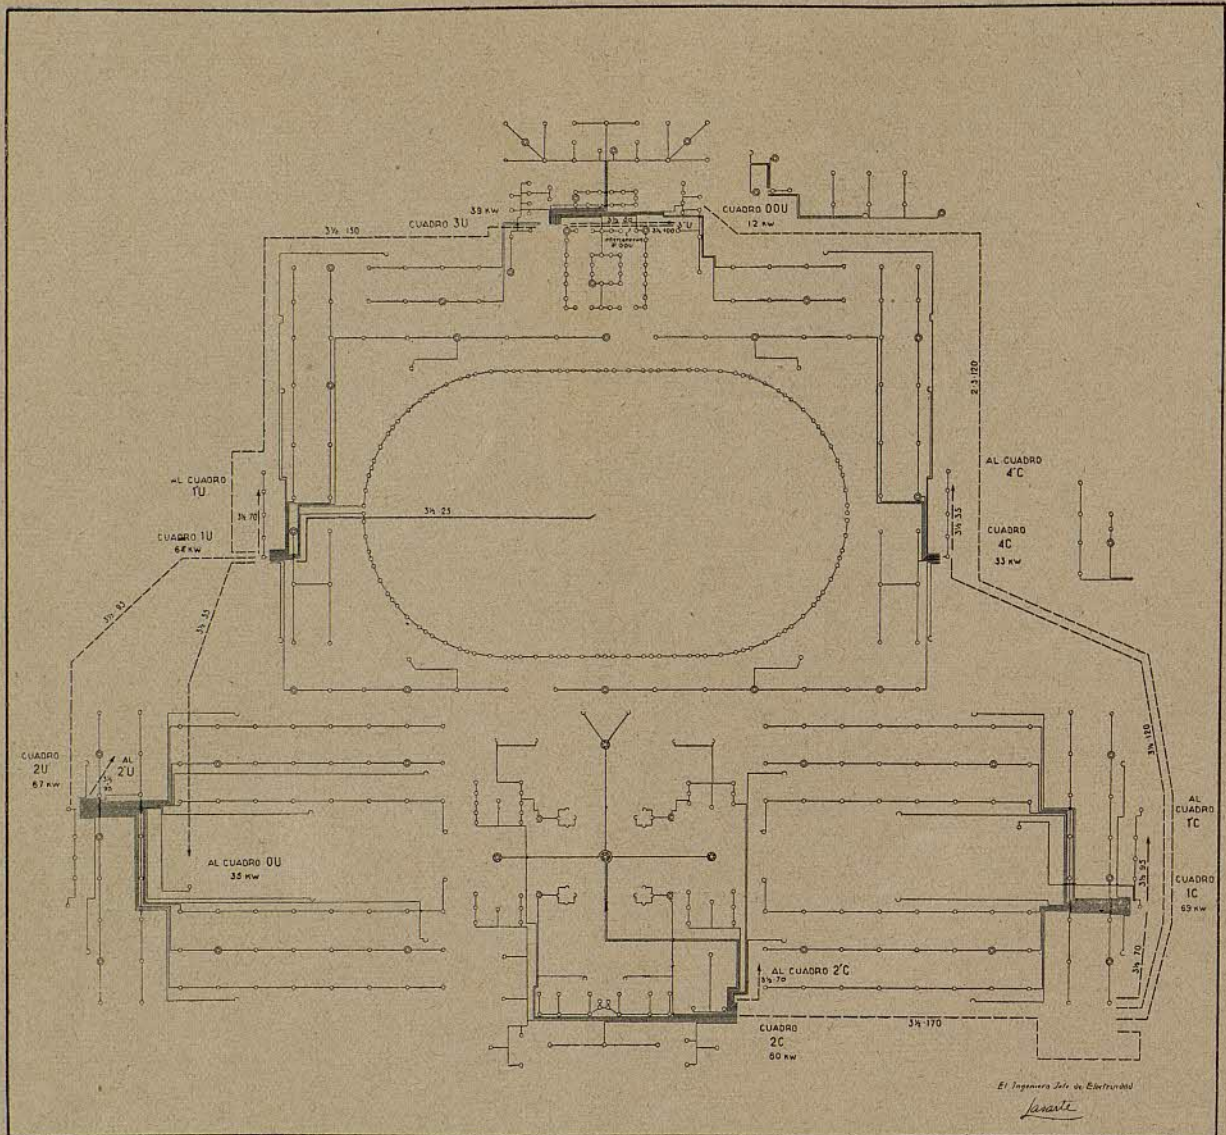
Palacio Nacional. Distribución eléctrica en la planta
